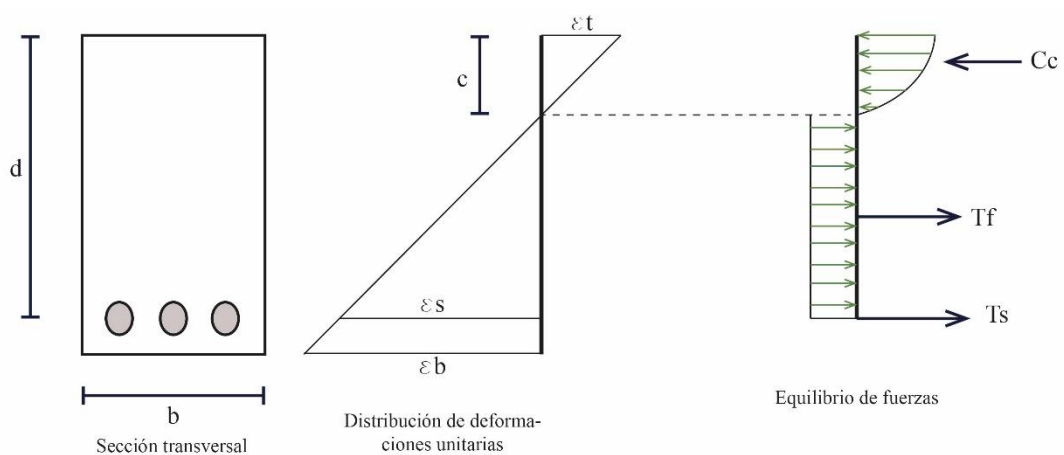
Distribución de deformación unitaria y equilibrio de fuerzas en vigas de hormigón reforzado con fibras de acero.
